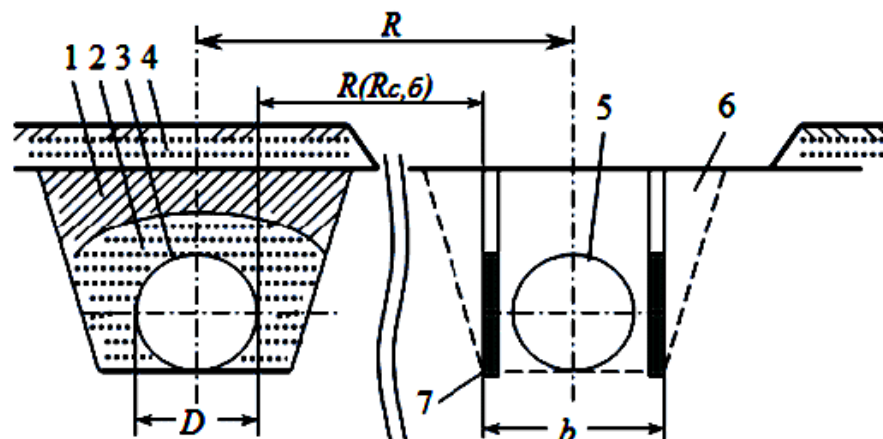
Схема розташування зарядів при спорудженні траншей поблизу діючого трубопроводу при розпушуванні мерзлого ґрунту:
